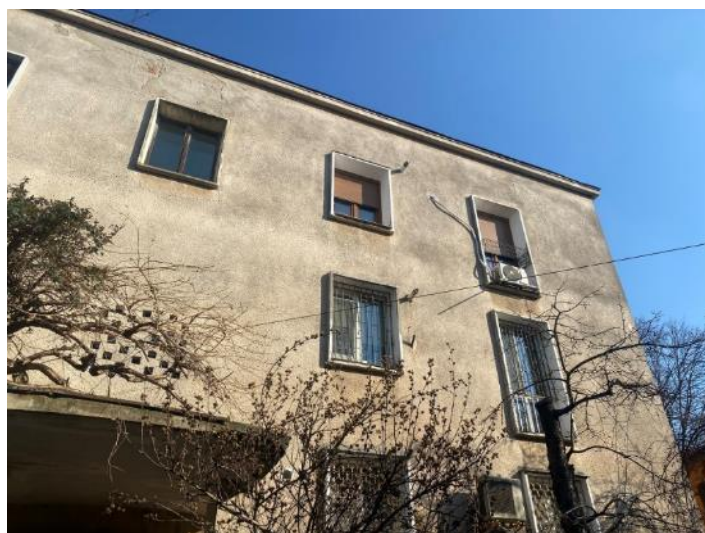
Clădire cu structura din zidărie nearmată și planșee flexibile la acțiuni în planul lor, amplasată în București
